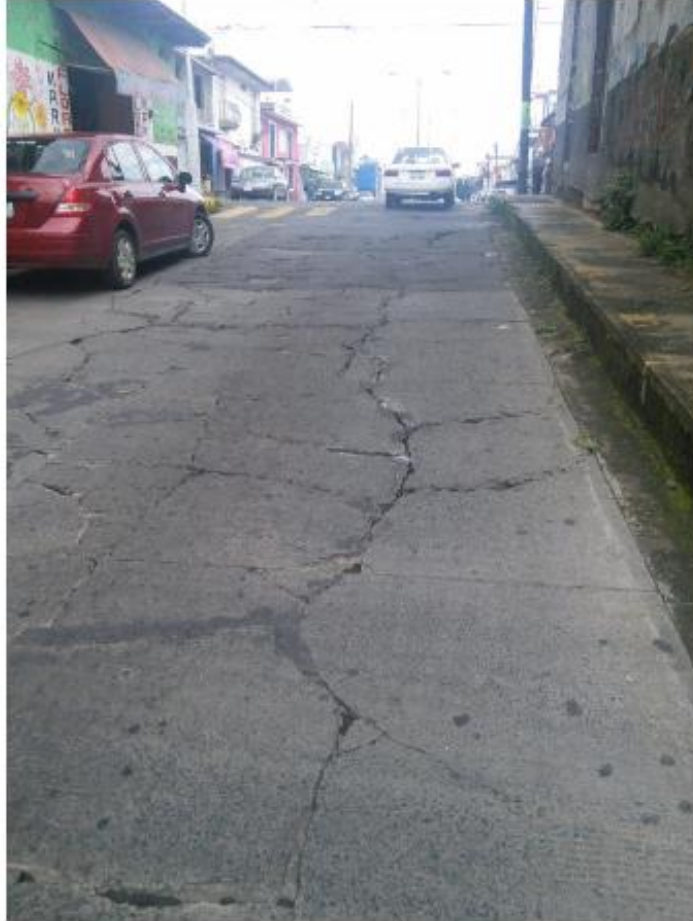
Pavimento fracturado calle Cupatitzio.
